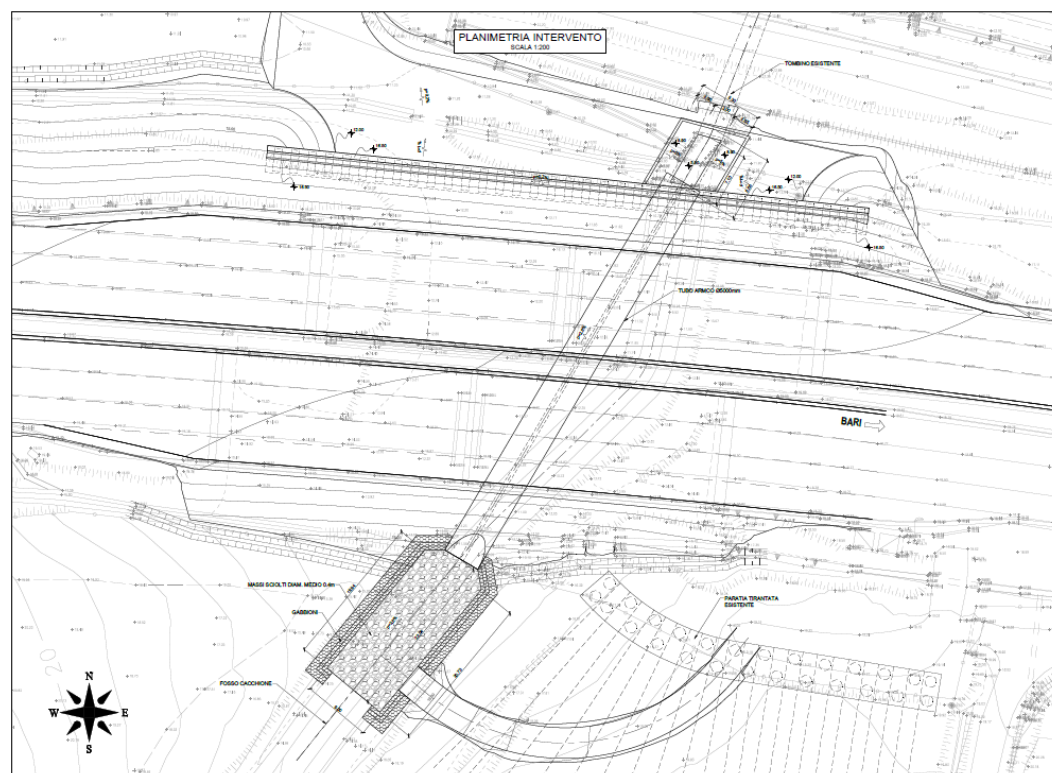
Planimetria sistemazione idraulica fosso Cacchione
